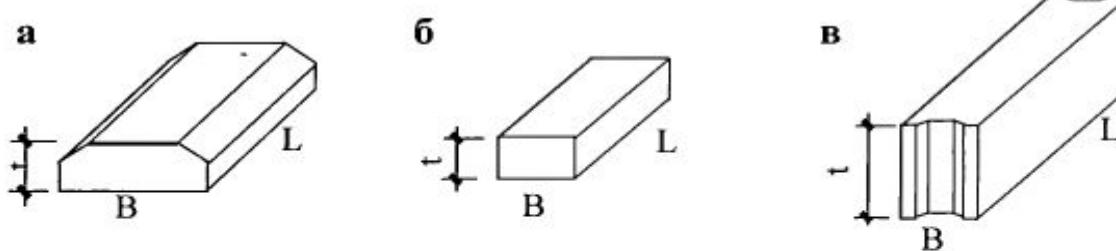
Сборные бетонные блоки ленточных фундаментов.
